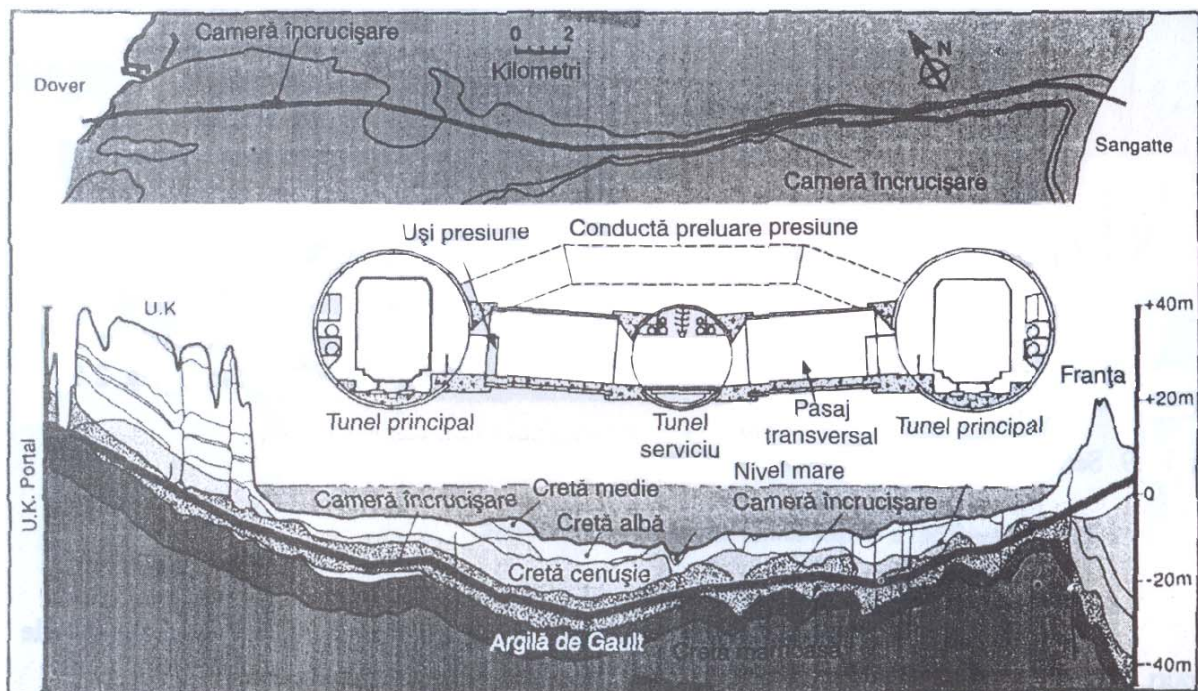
Tunelul pe sub canalul Minecii (Plan de situatie, sectiune transversala, profil in lung)
